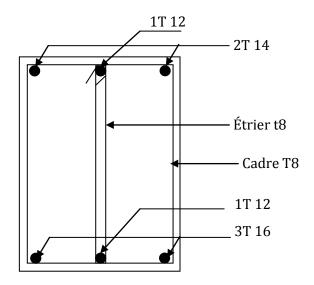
Schéma de ferraillage de la 2ème poutre brisée
